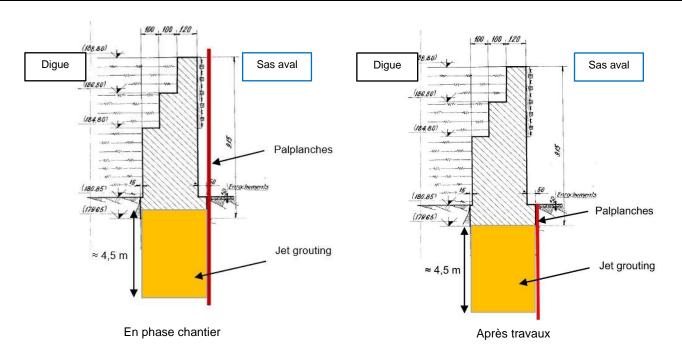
Schéma de principe du jet grouting en fondation du mur et derrière le rideau de palplanches – vue en coupe (Source : EDF)
